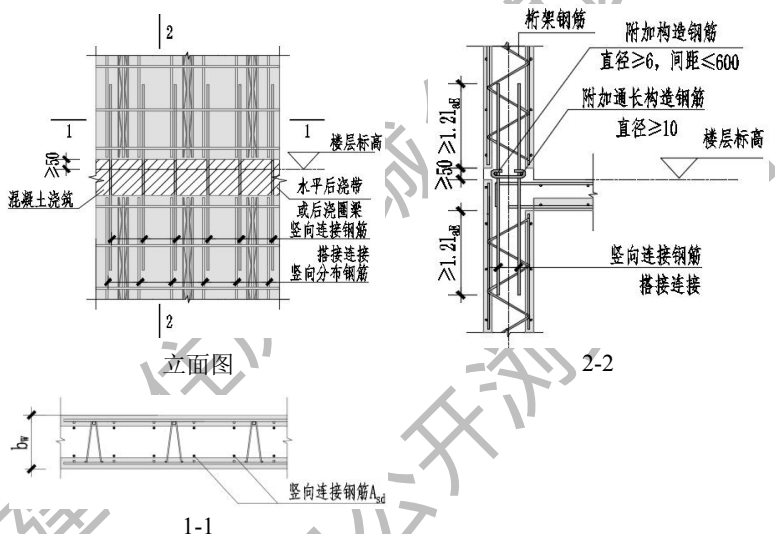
预制剪力墙墙身区域竖向连接钢筋的构造要求
